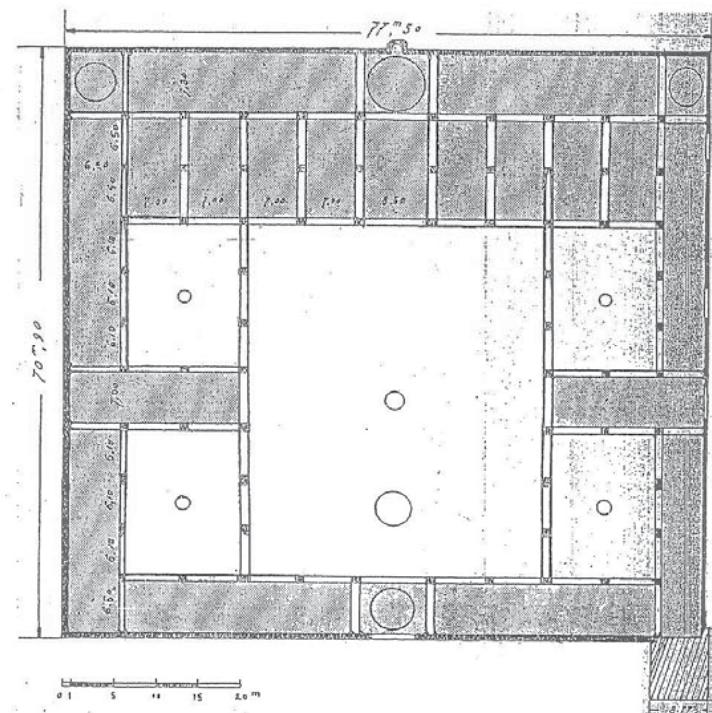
جامع تينمل، مسقط أفقى، عن:
